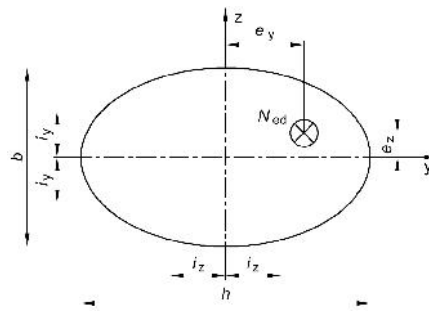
Sezione soggetta a presso o tensoflessione devianta.
